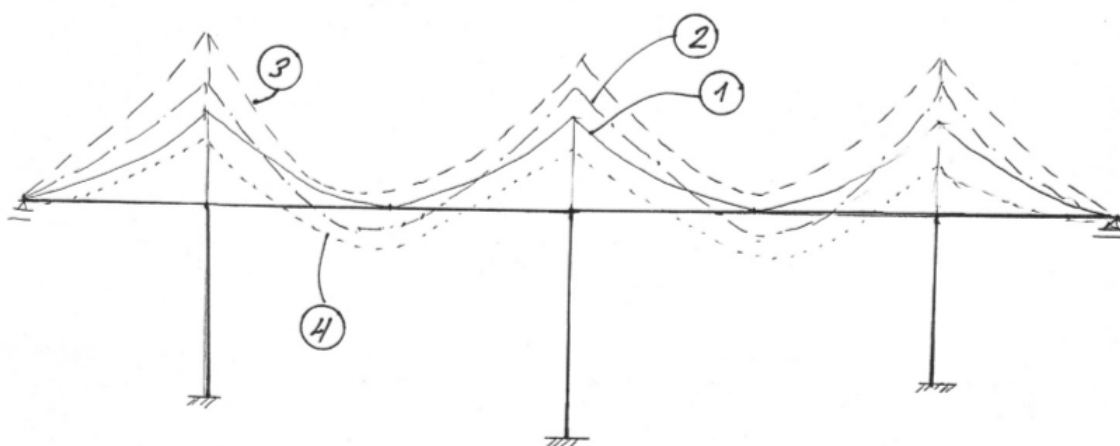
Напрягаща армировка и моменти в строително състояние:
